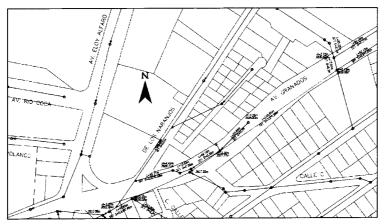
Red de alcantarillado Av. Eloy Alfaro tramo sur
